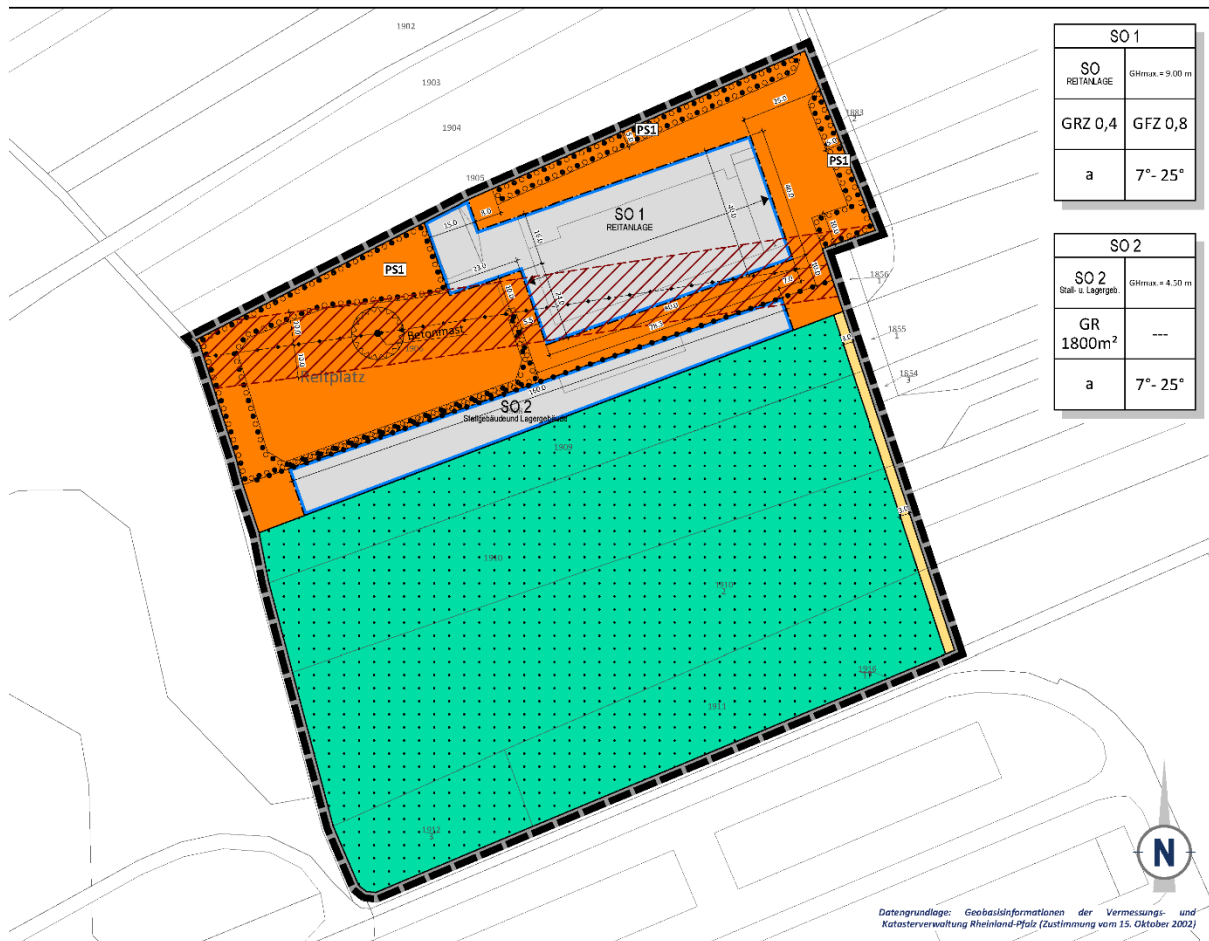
Bebauungsplan "Im Buchholz – 1. Änderung"
